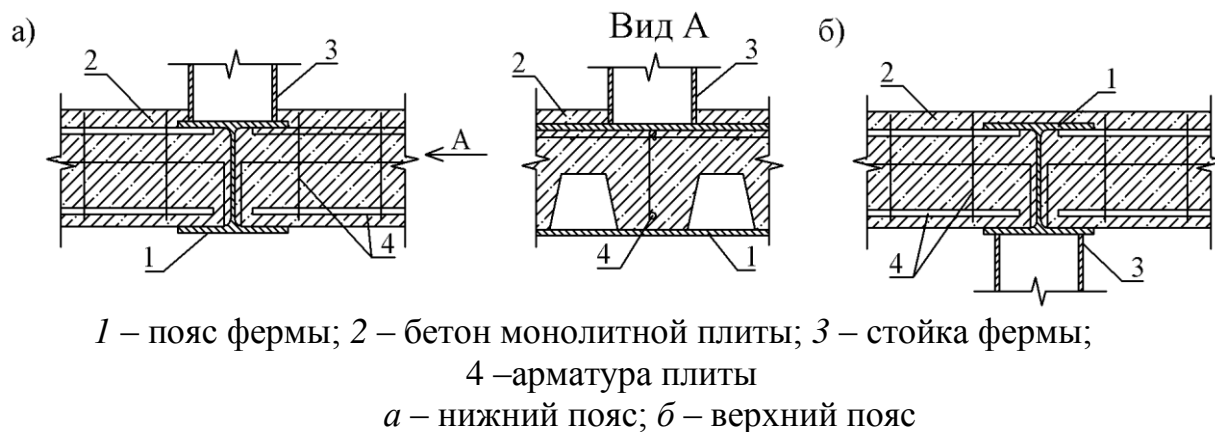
Принципиальная схема узла сопряжения монолитного перекрытия по профилированному настилу и поясов фермы
